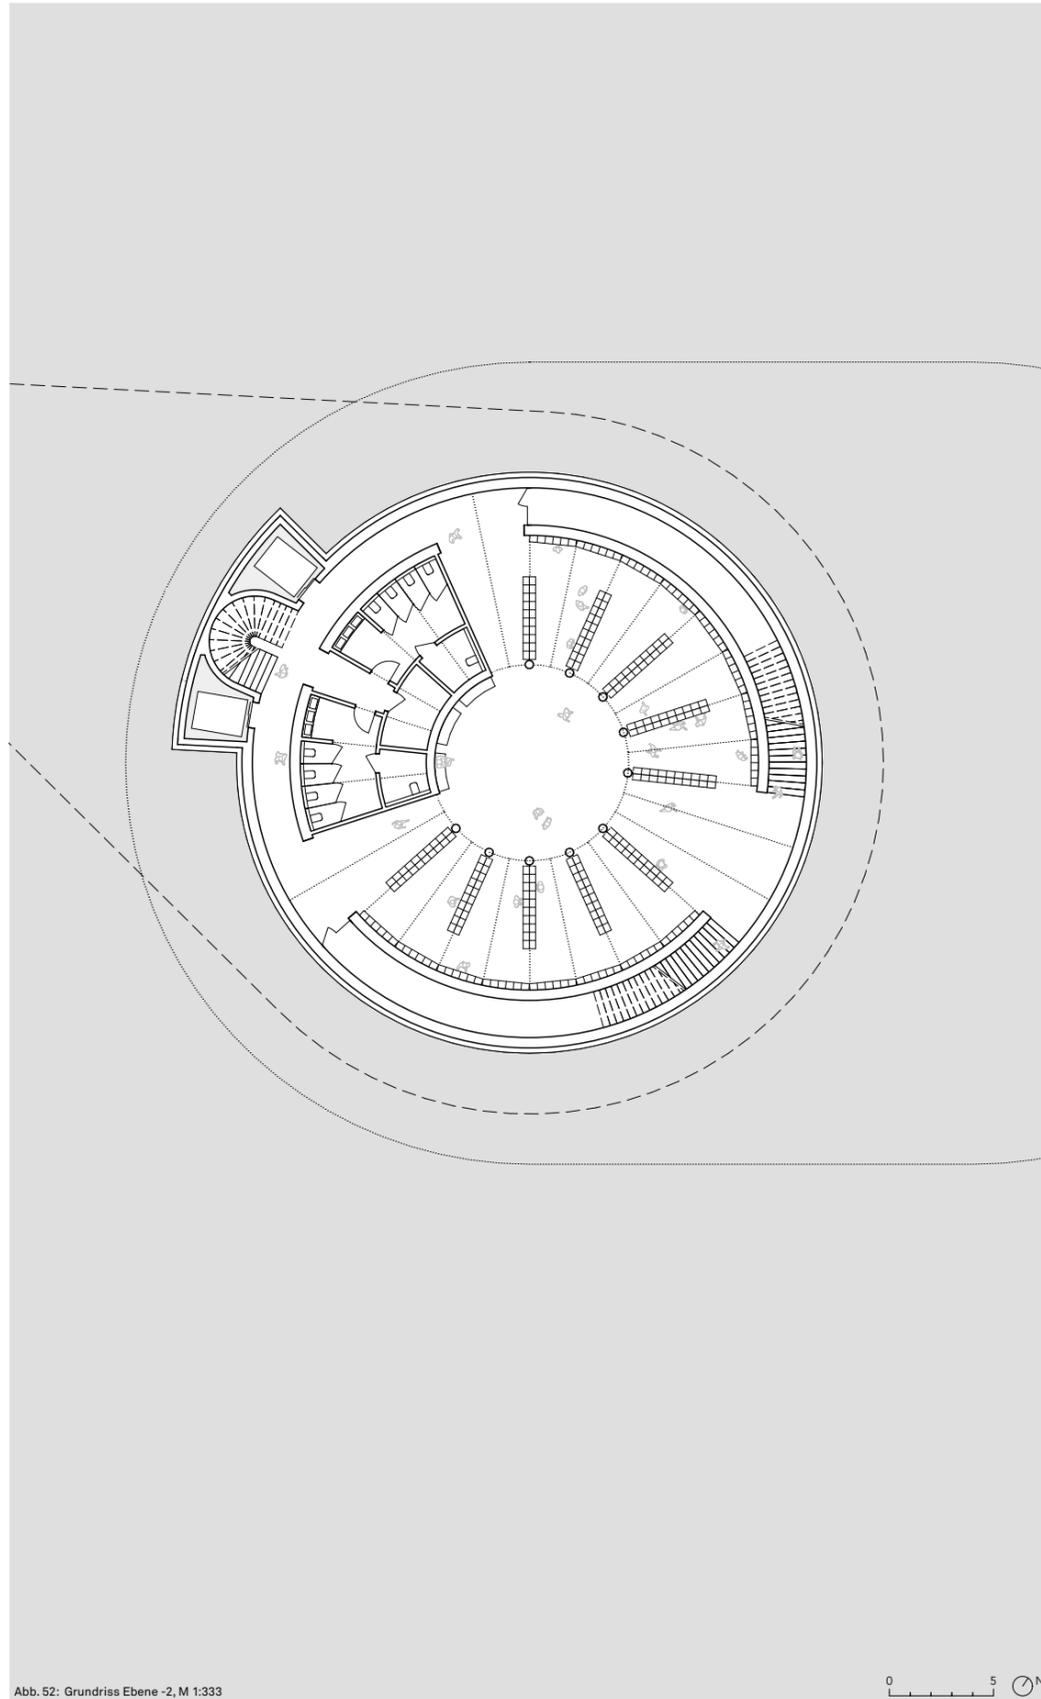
Grundriss Ebene -2, M 1:333
